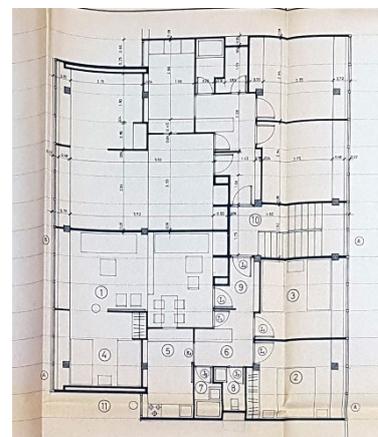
Planta Distribución B-3-3. 1964. Fuente: Archivo Municipal da Coruña
